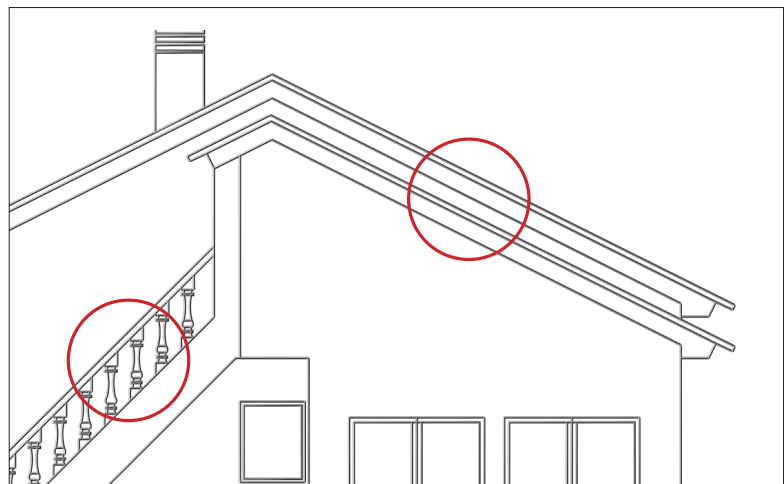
e 37 - Pormenor de alguns erros existentes na planta em relação à casa.
